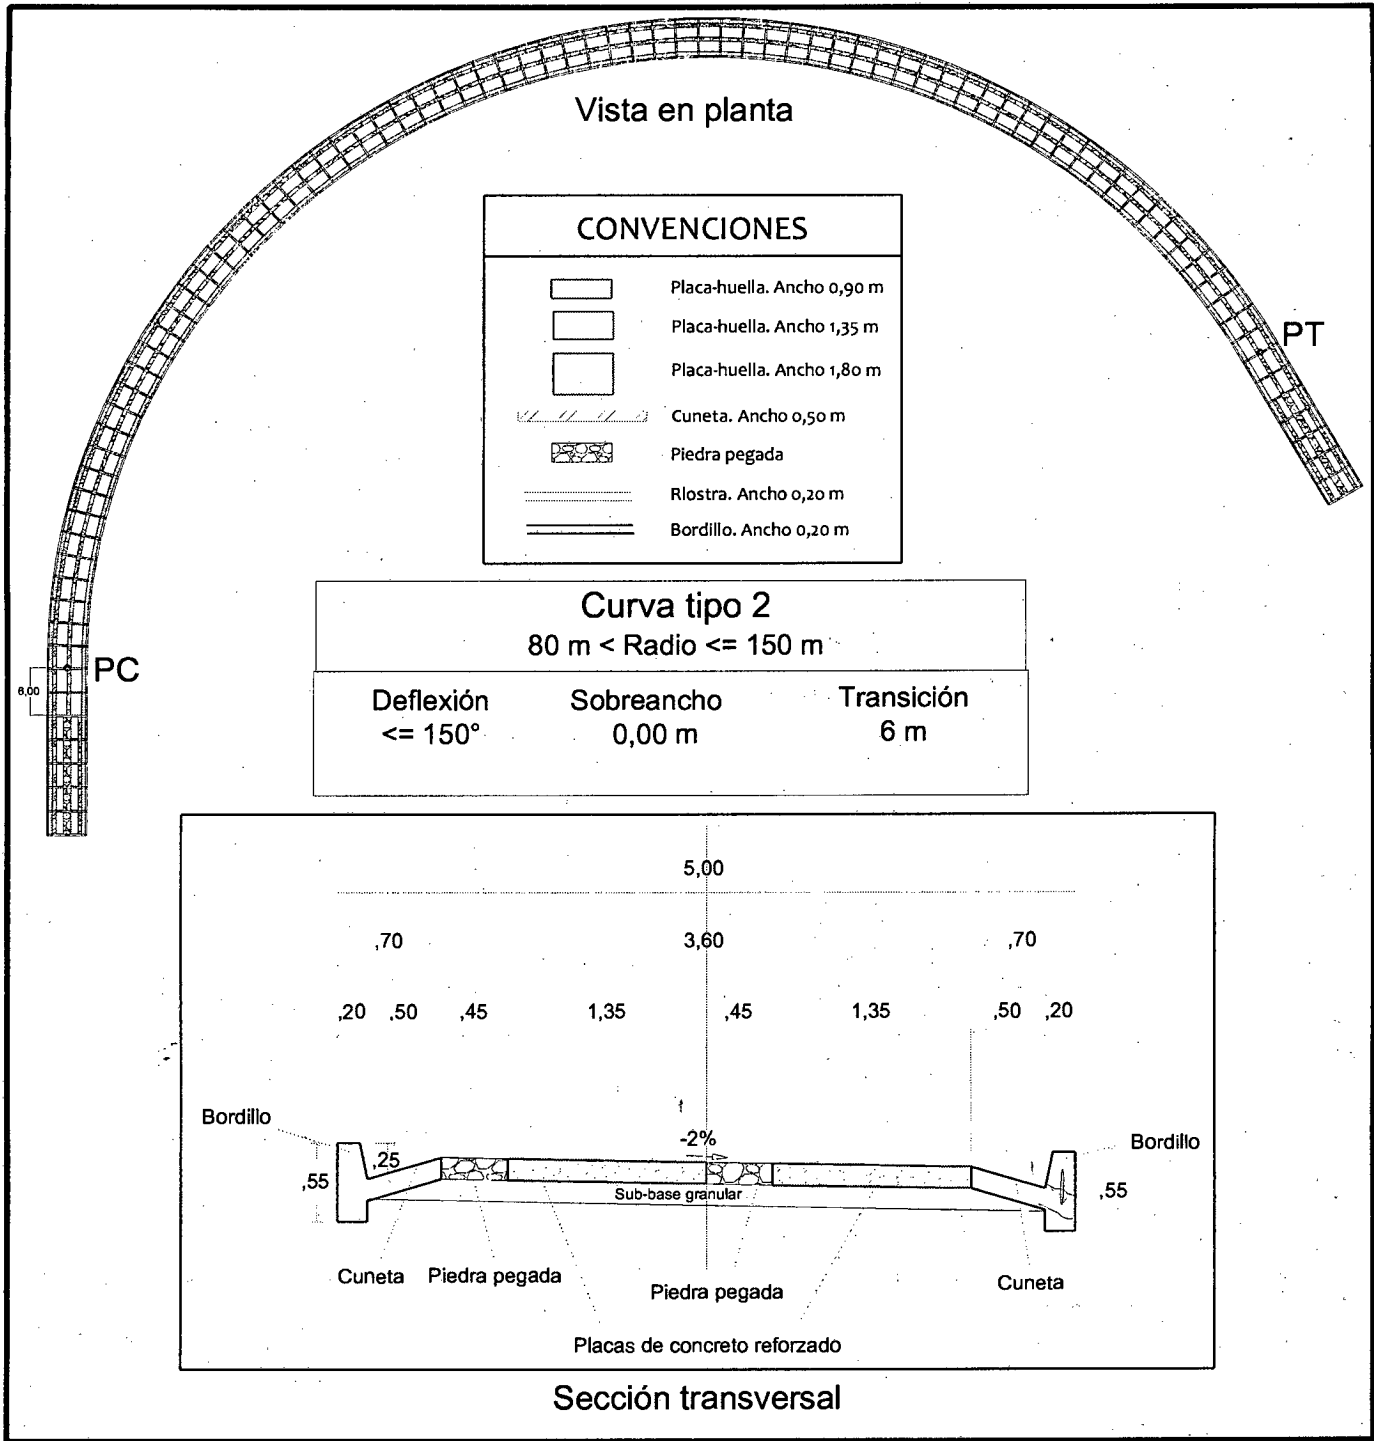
Vista en planta y perfil de la sección transversal en curvas TIPO 2 Δ ≤ 150° y 80 m < Rc ≤ 150 m
